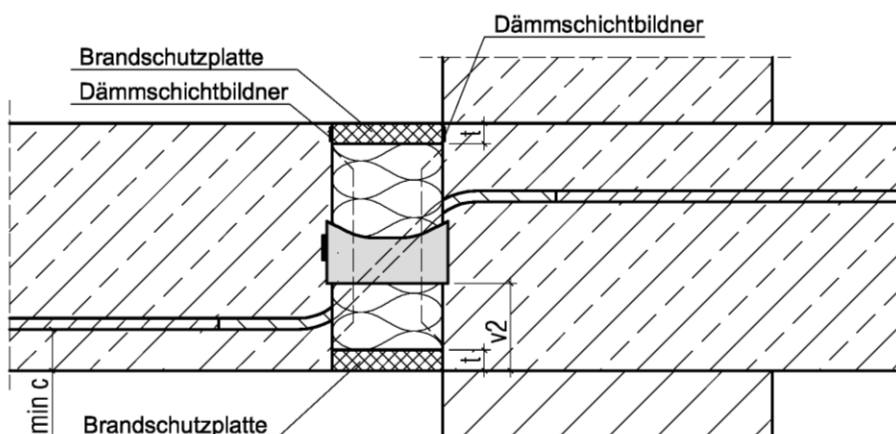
Schöck Isokorb® Typ Q (Ausführungsvariante A) gem. Abschnitt 3.1.2, Var. b)
